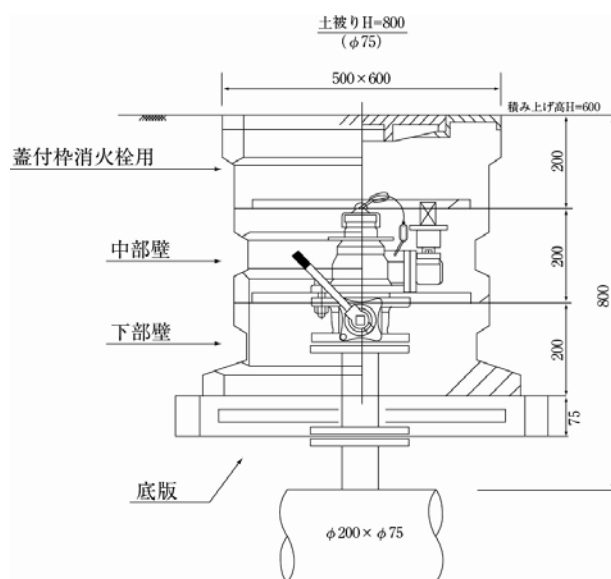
単口消火栓室の設置例 (単位: mm)
